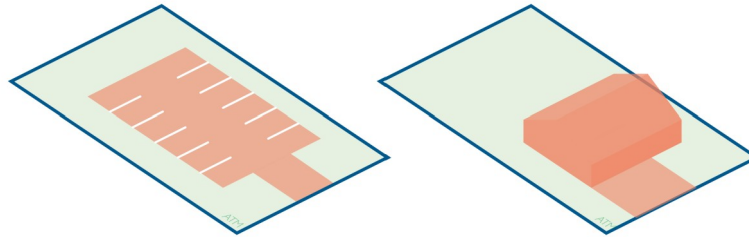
Cas d'un aménagement nouveau ou d'une construction nouvelle
